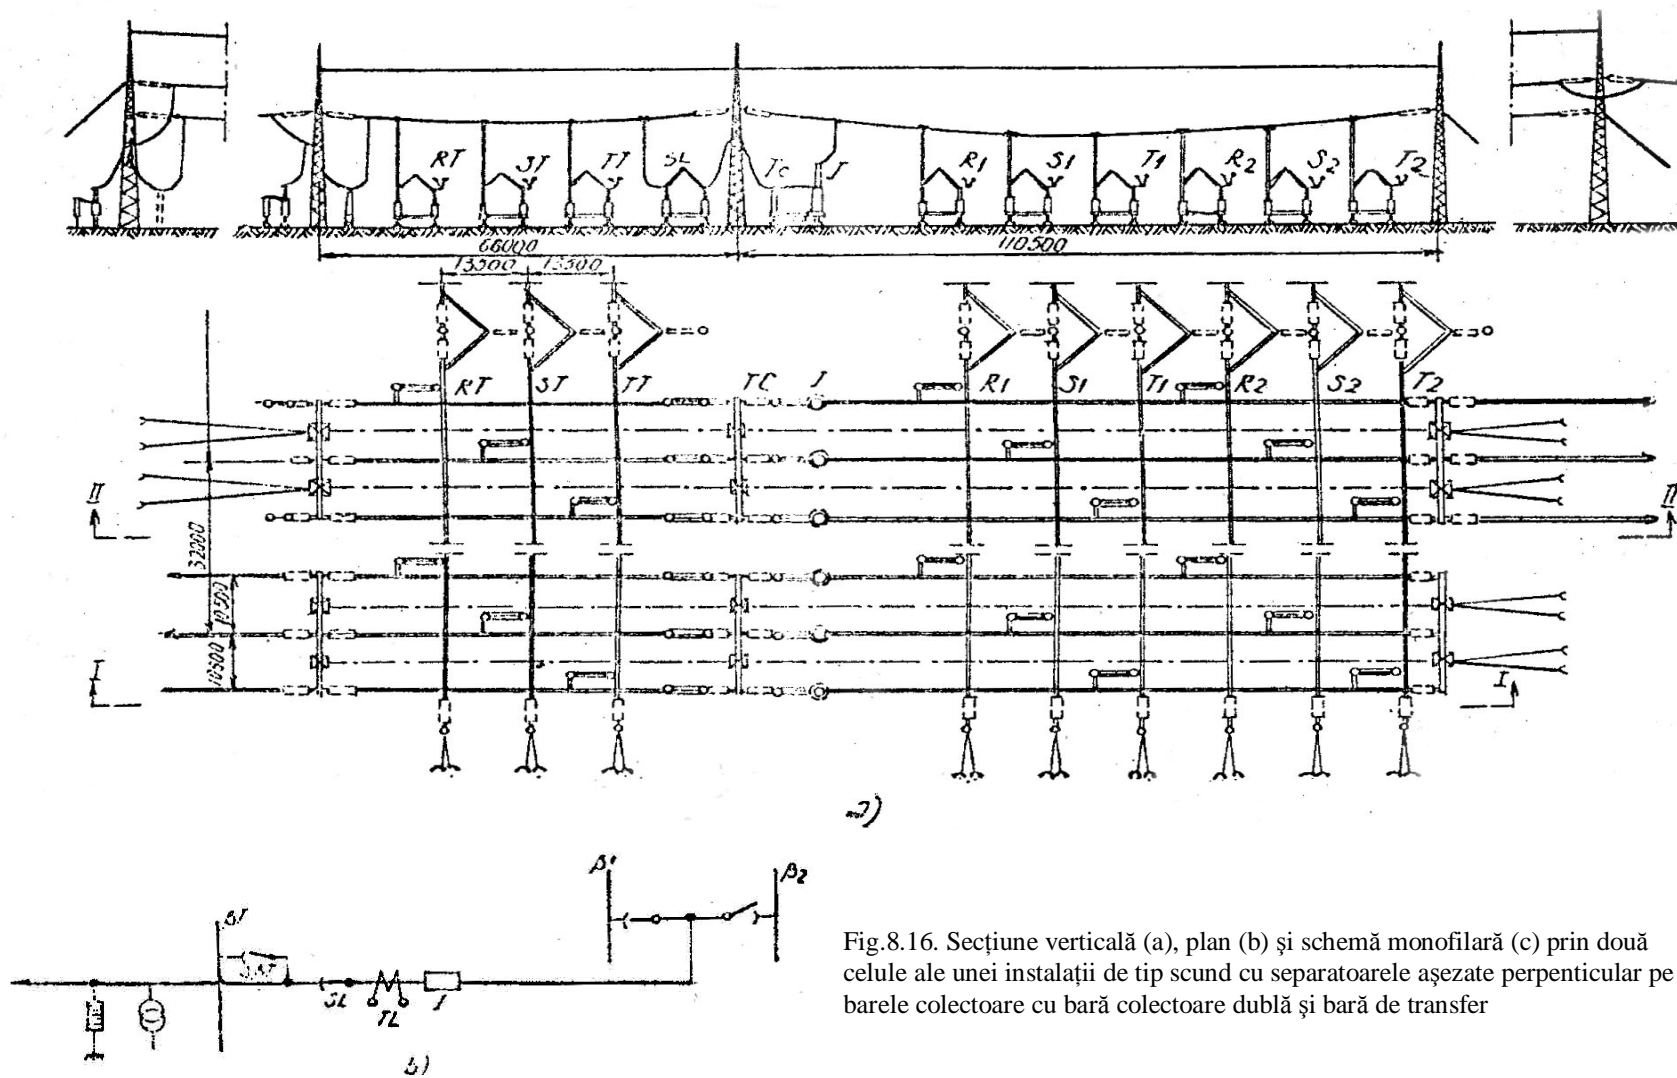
Secțiune verticală (a), plan (b) și schemă monofilară (c) prin două celule ale unei instalații de tip scund cu separatoarele așezate perpendicuar pe barele colectoare cu bară colectoare dublă și bară de transfer
